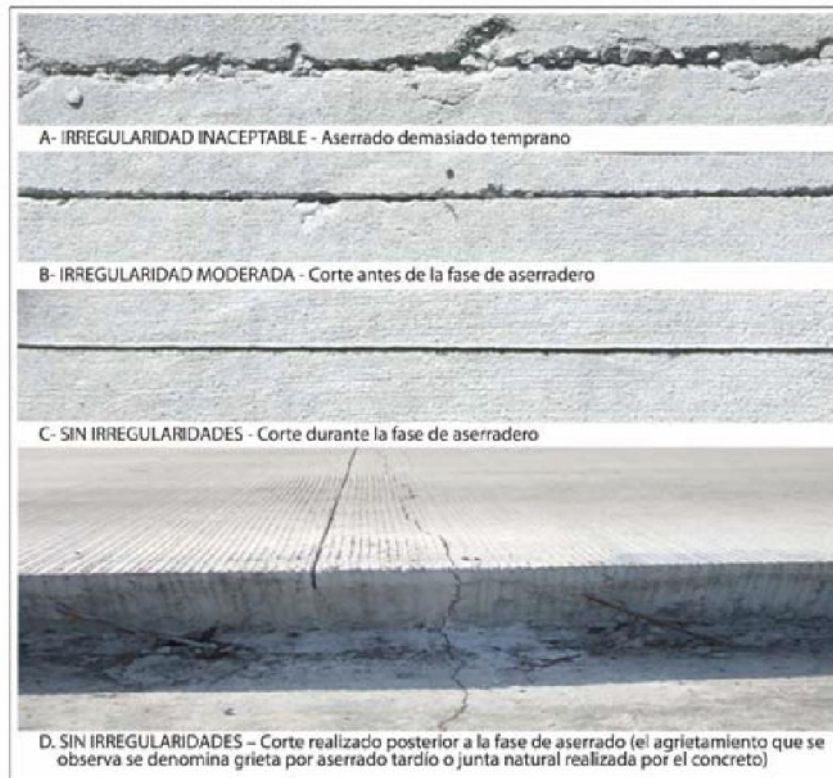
Aserrado Temprano o Tardío de los Pavimentos de Concreto.
